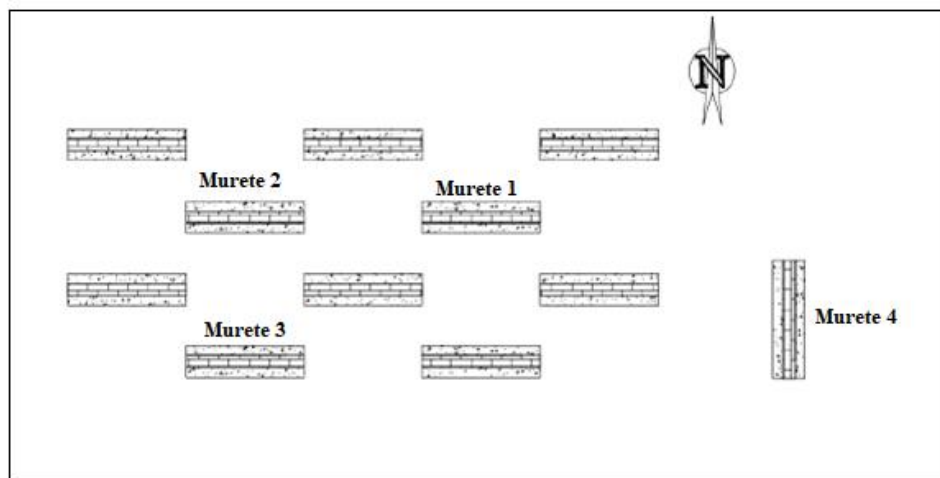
Planta com a localização e exposição dos muretes na Estação de Exposição Natural de Alvenarias e Rebocos da FCT NOVA
